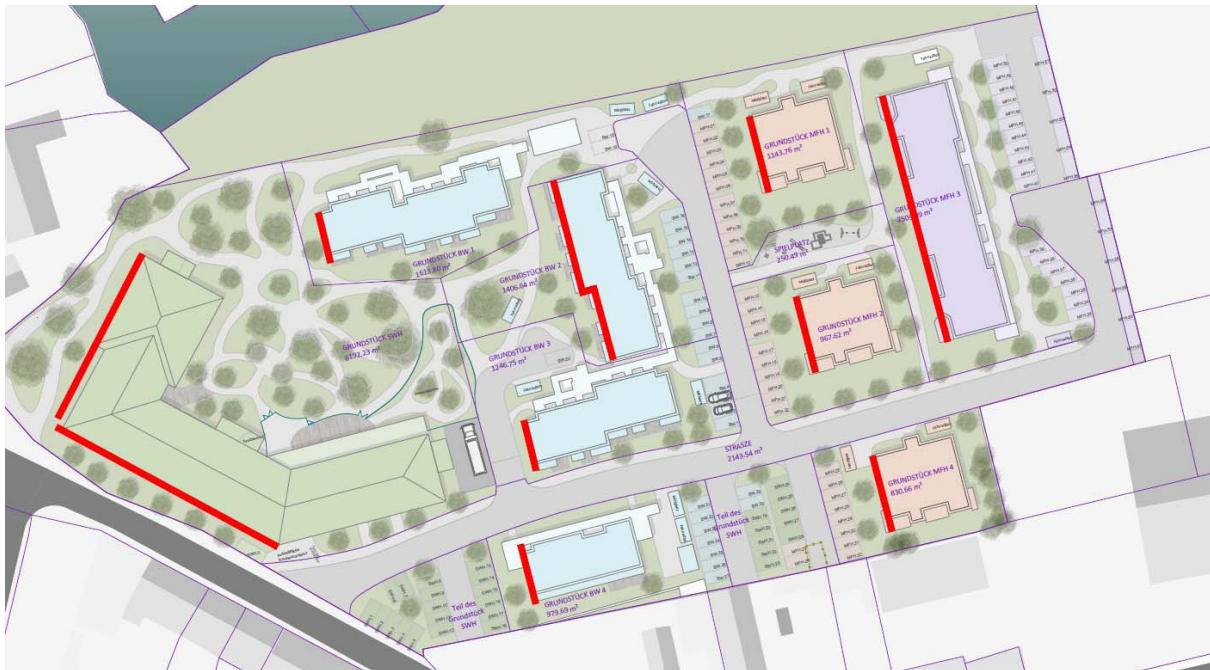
Verortung der von der BAB 13 lärmabgewandten Gebäudefassaden (rot markiert)⁴
